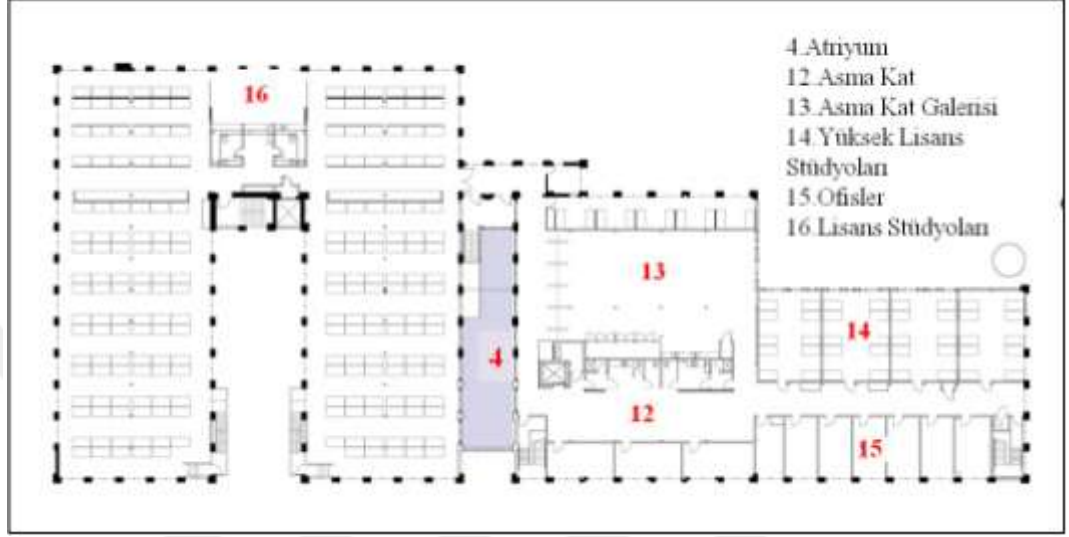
Waterloo Mimarlık Okulu zemin kat planı (Anonim 2009)
